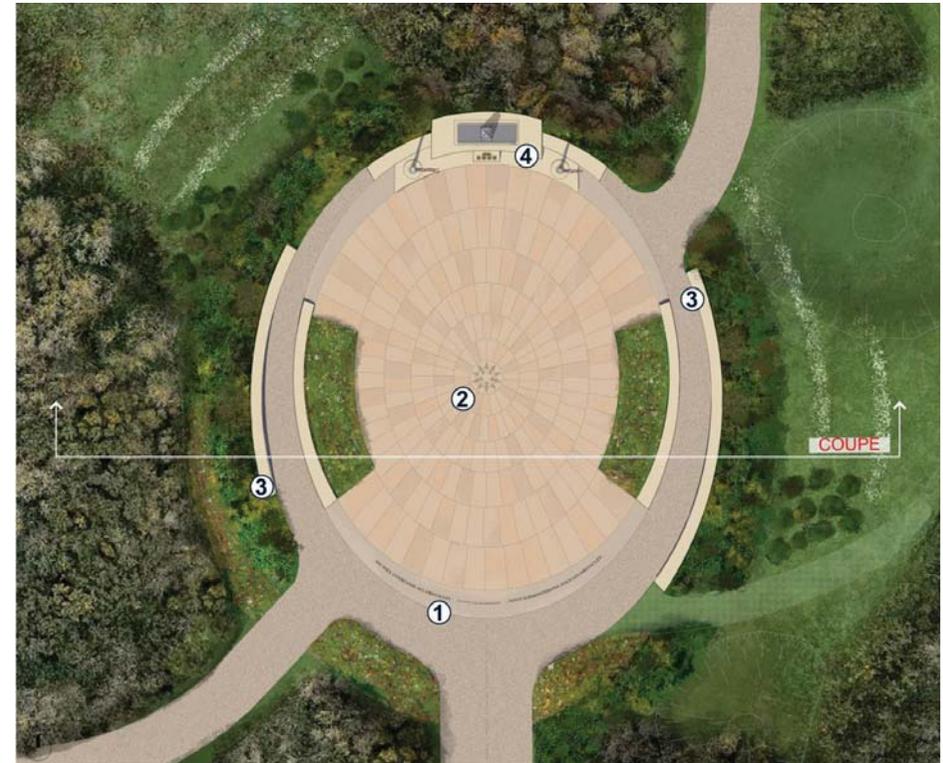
Plan de la place commémorative - Source : Permis de construire
